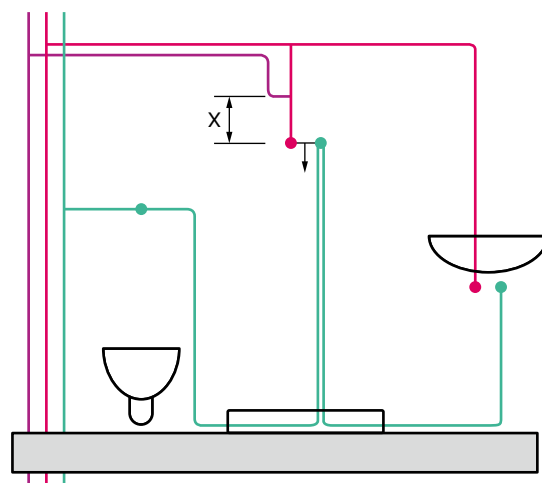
Collegamento di valvole di miscelazione a flusso costante attraverso tubi dell'acqua calda - esempio di collegamento dall'alto
